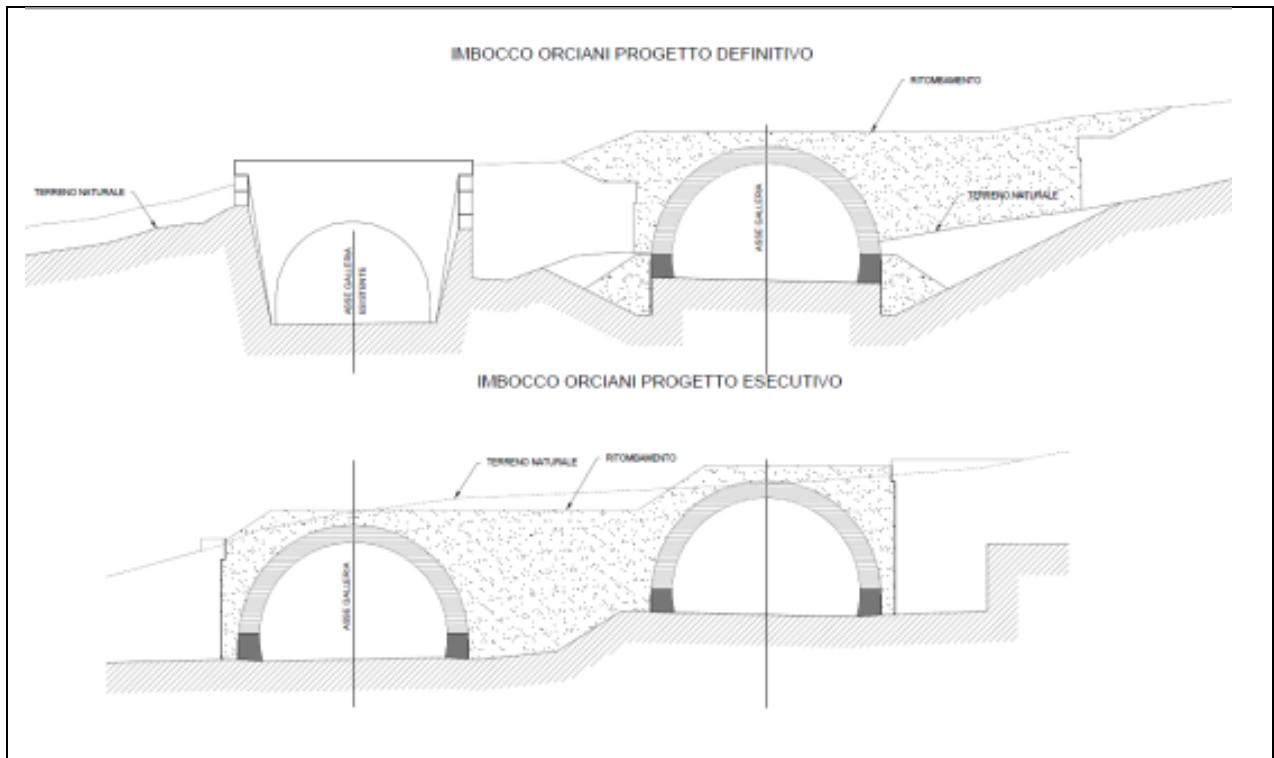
Confronto imbocco Orciani tra progetto definitivo e progetto esecutivo
